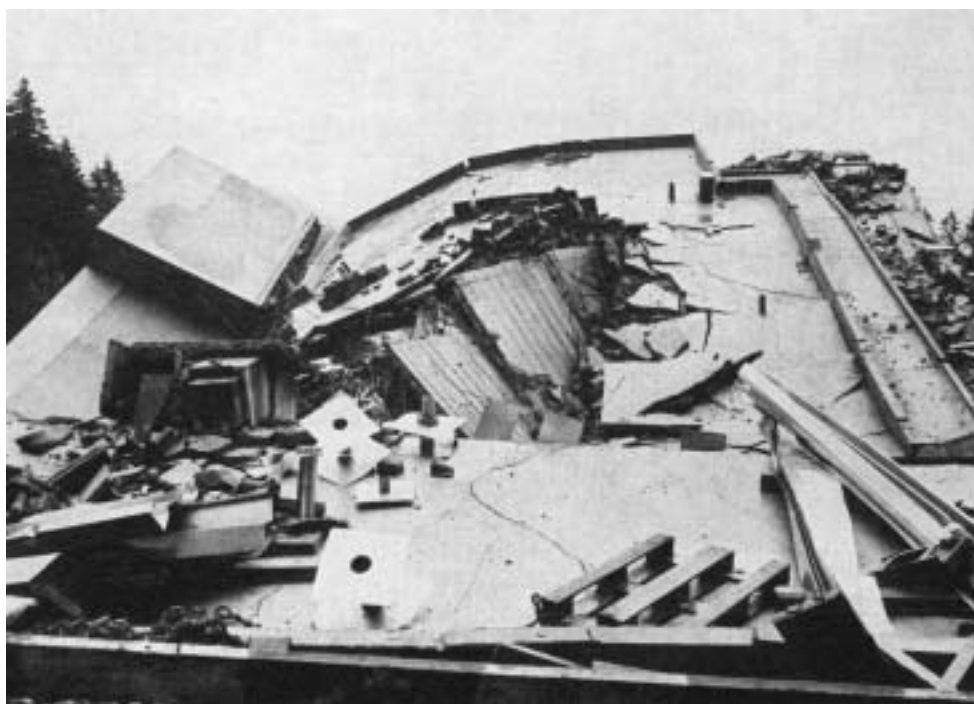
O deslizamento de uma sapata sobre um terreno inclinado provocou a ruína total deste hotel em construção
